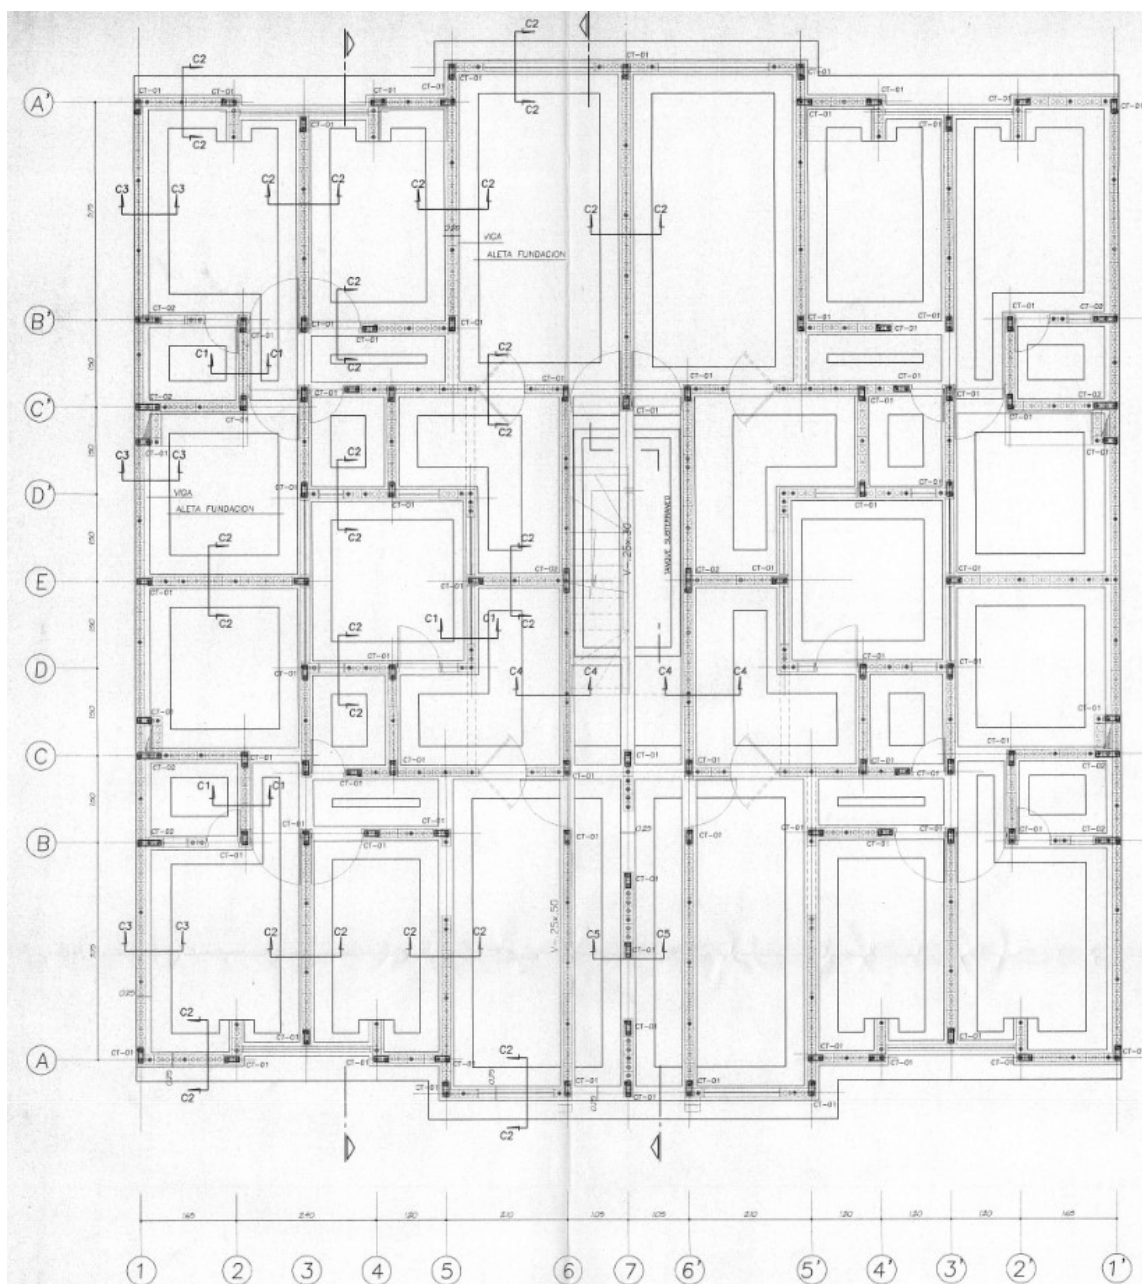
Cimentación Bloque, conformada por vigas T invertida. (Fuente. Plano estructural 01).
